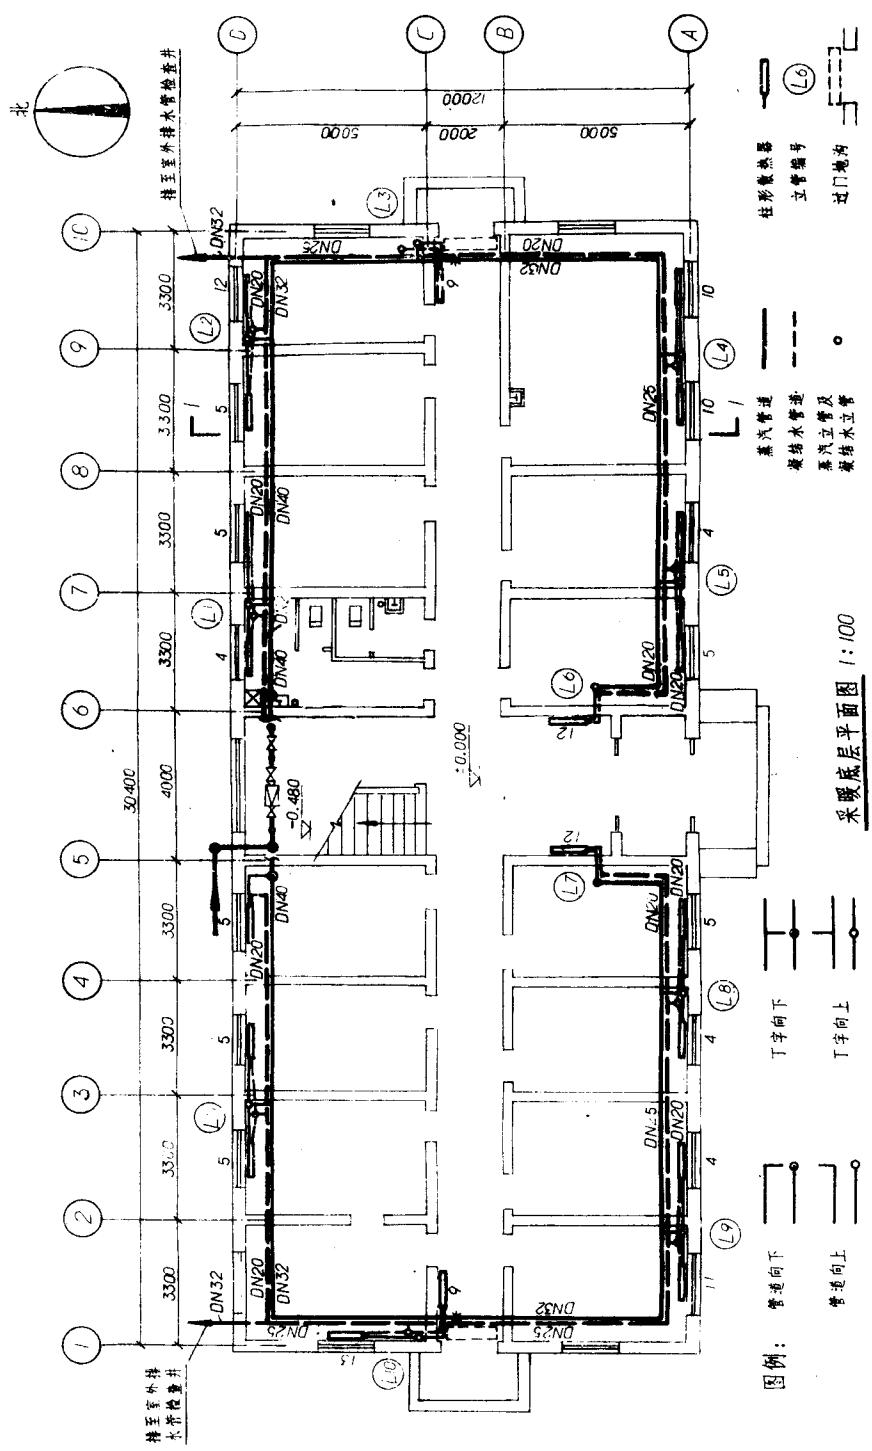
a 某厂办公楼采暖系统布置底层平面图
